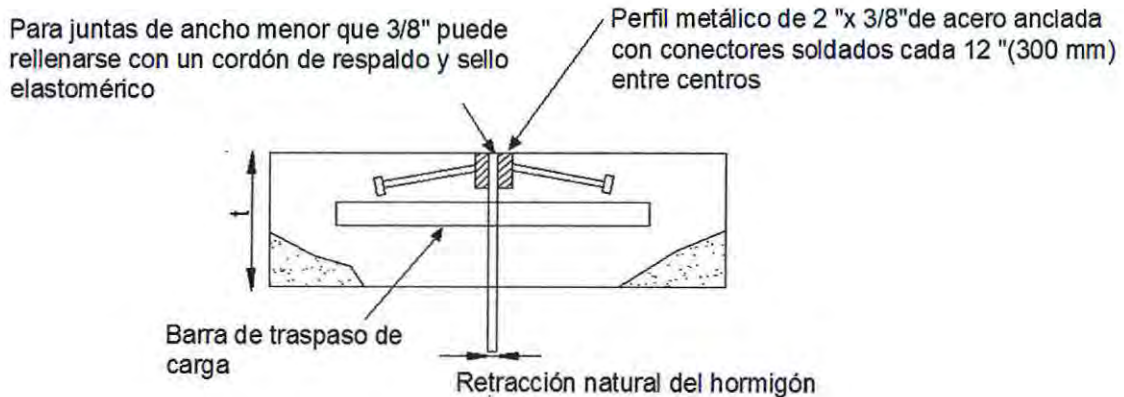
Detalle de junta de construcción protegida con cantonera (ACI 360R-10).
